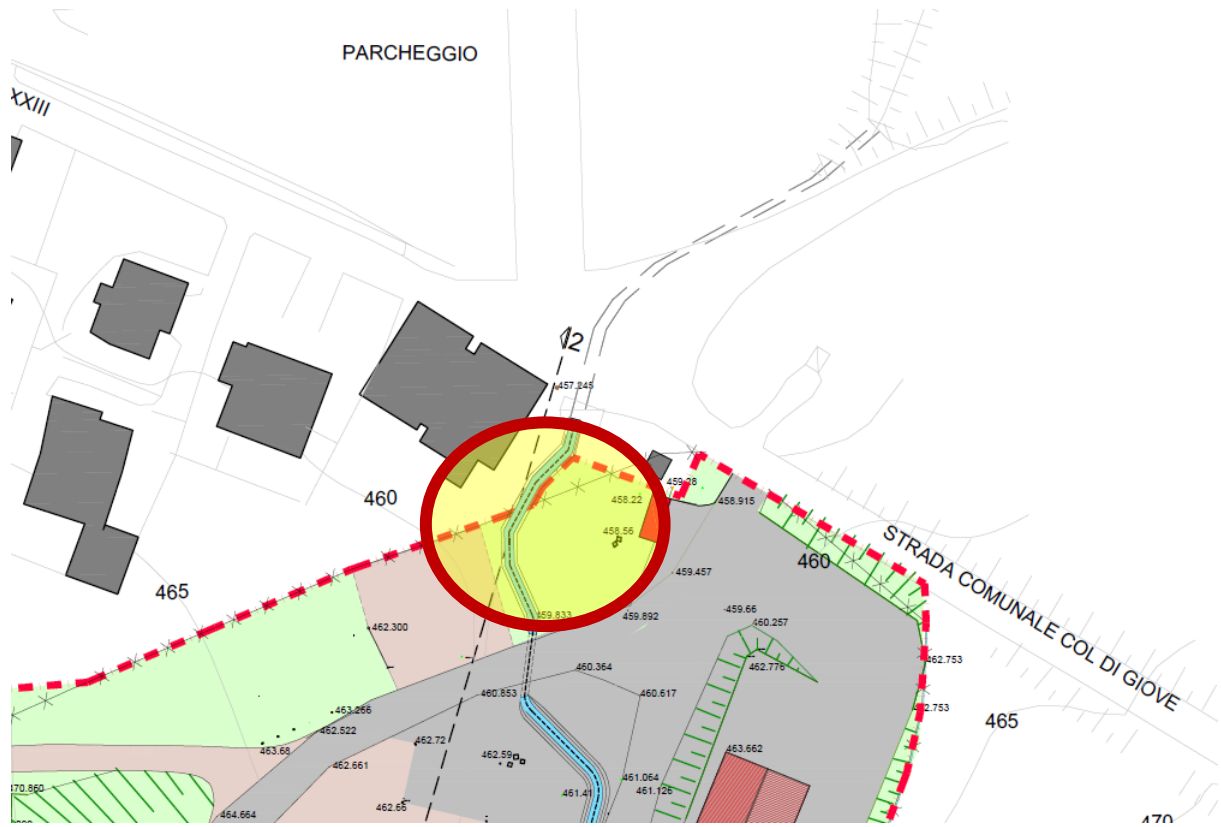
Planimetria con indicazione della sezione di verifica a valle
